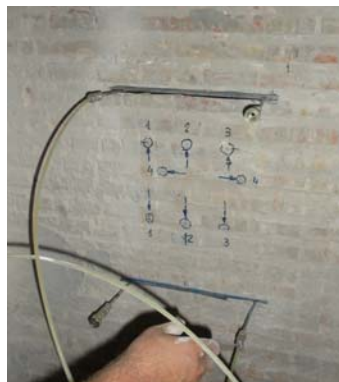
Ensayo de gato plano doble nº 2 en un muro de ladrillo de la planta primera del inmueble (Cortesía de Aidico).
